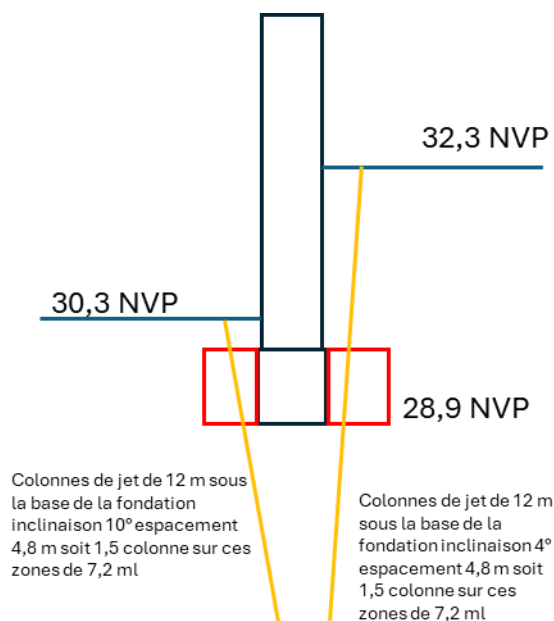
Schéma des tirs des lignes de colonnes de jet de la fondation de la façade contemporaine au droit des zones hors influence des poteaux inclinés 1001 à 1006
